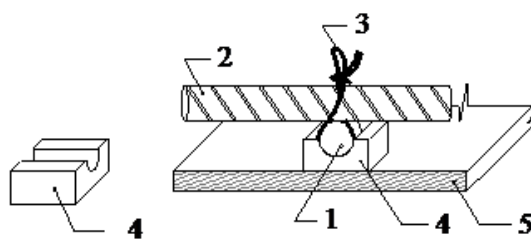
Установка фиксаторов арматуры: 1-продольной стержень; 2 – поперечный стержень; 3 – вязальная проволока; 4 – фиксатор; 5 – палуба
